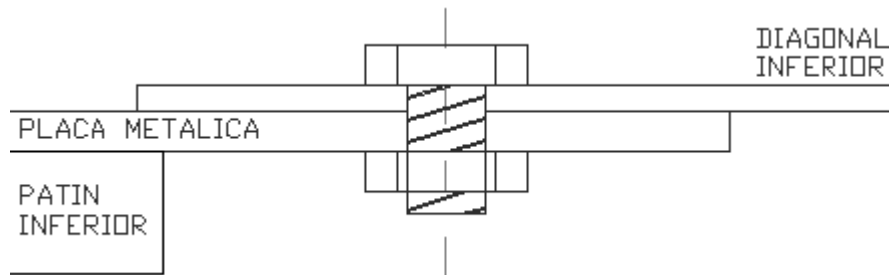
Detalle de conexión apernada placa metálica-diagonal inferior
